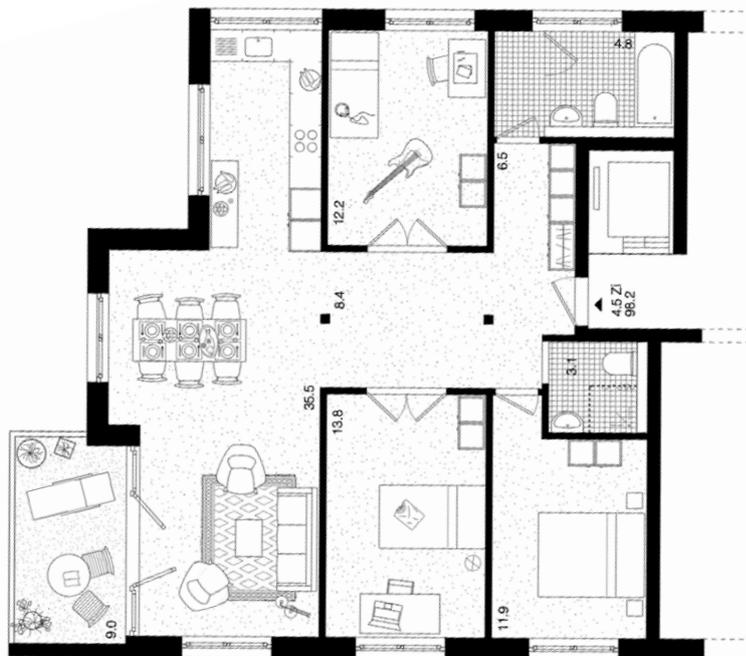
Wohnungsgrundriss 4.5 Zimmer - Whg.
